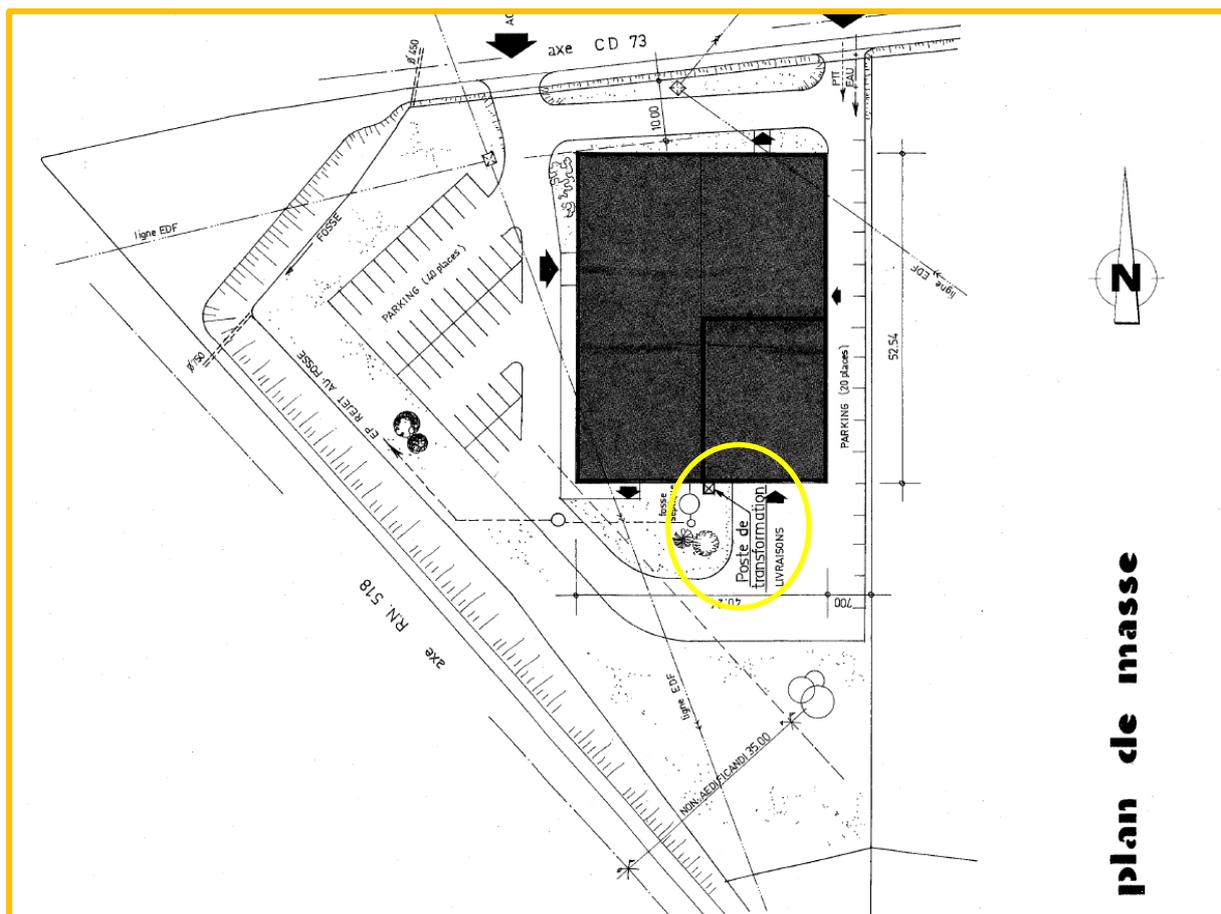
Schéma du plan de masse actuel du site (sans échelle)
